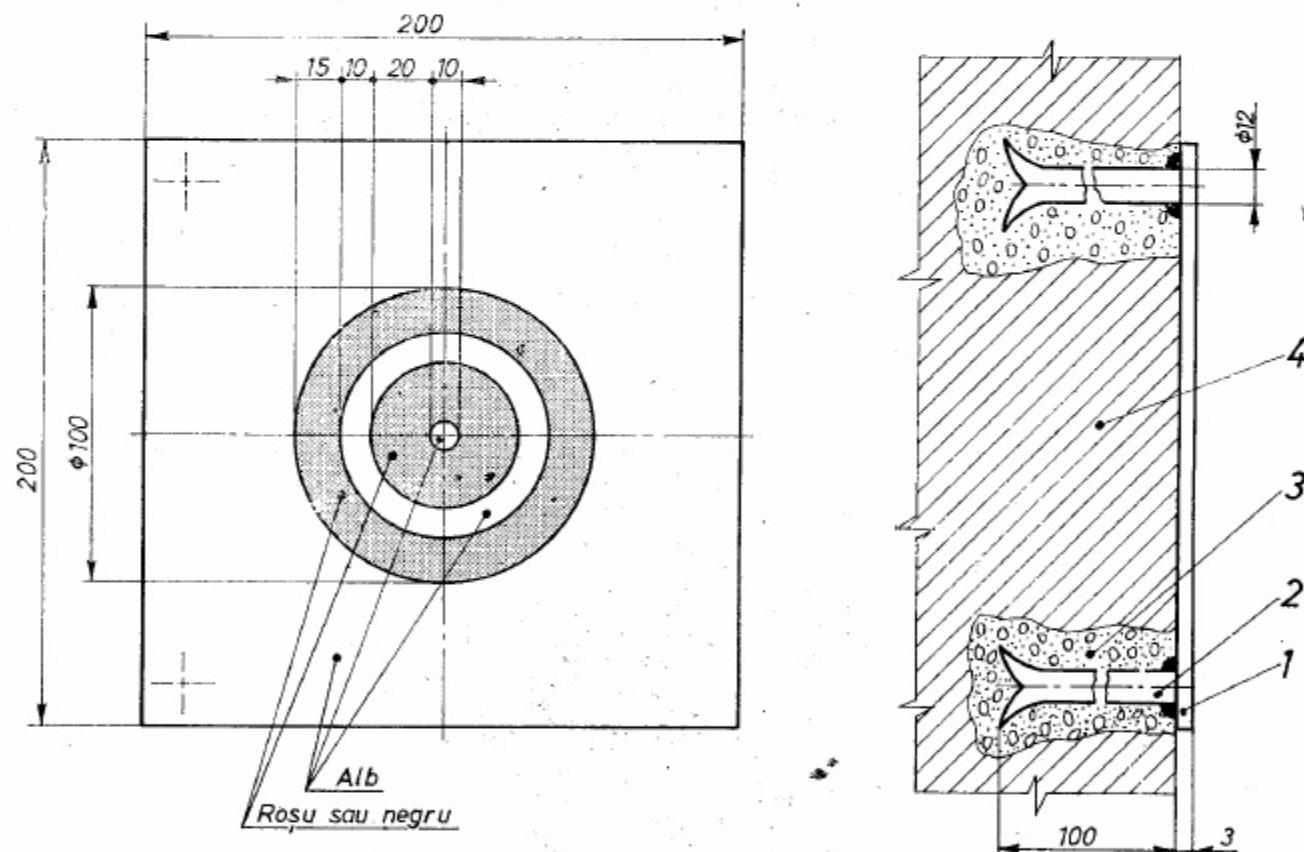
1 — placă metalică; 2 — ancore; 3 — beton simplu; 4 — elementul de construcție
